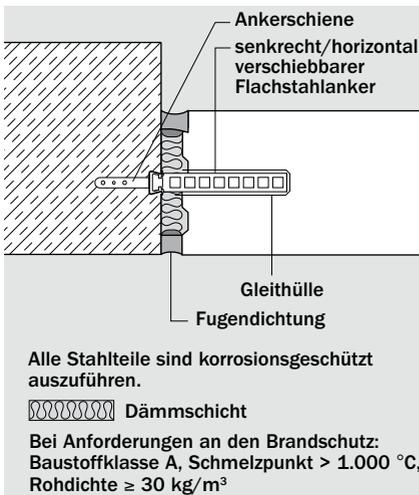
/32: Wandanschluss an eine Stahlbetonstütze mit Ankerschienen
